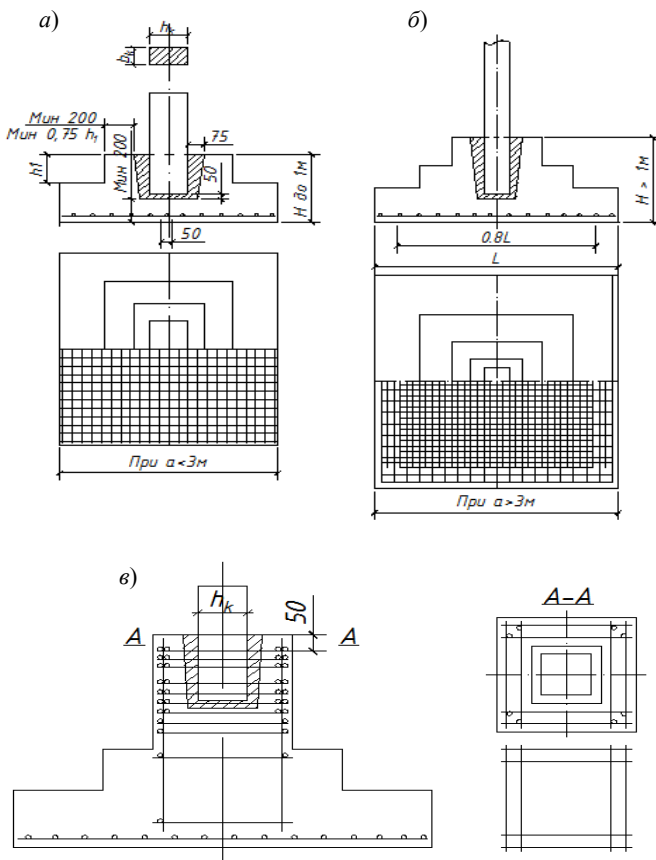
Армирование отдельных фундаментов с низкой стаканной частью:
